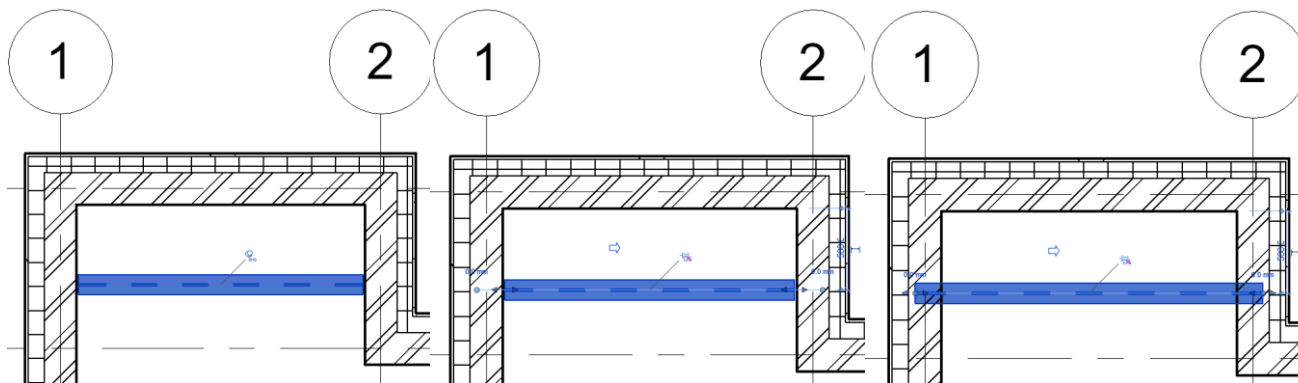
Widok (rzut w górę) po wstawieniu układu belek
